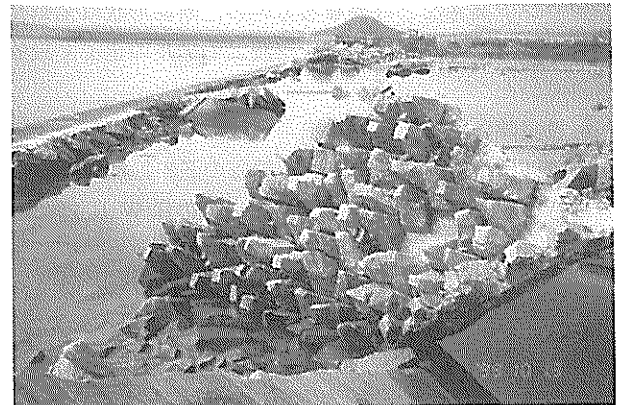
山口港山口地区堤防 堤防コンクリート倒壊状況
